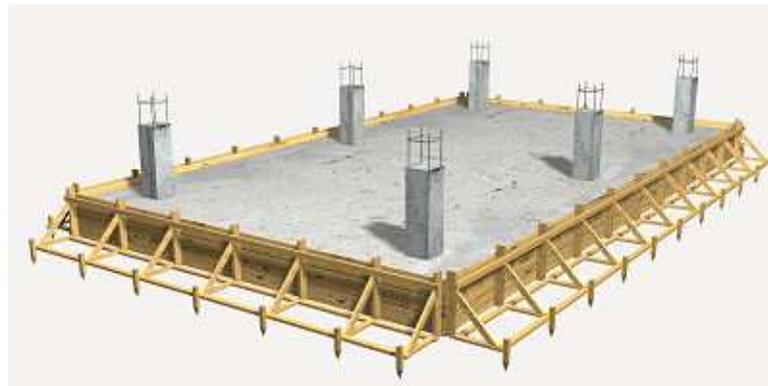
Estructuración y fundición de losas y columnas (DÍAZ, 2015)
